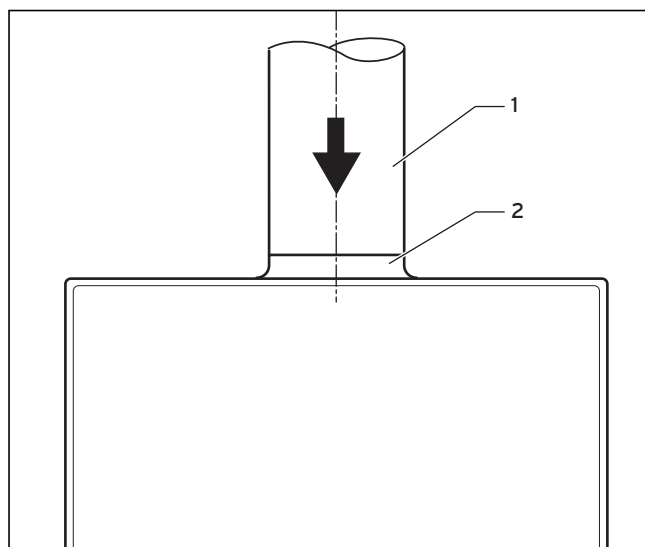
Przykład montażu: Pionowy przepust przez dach
